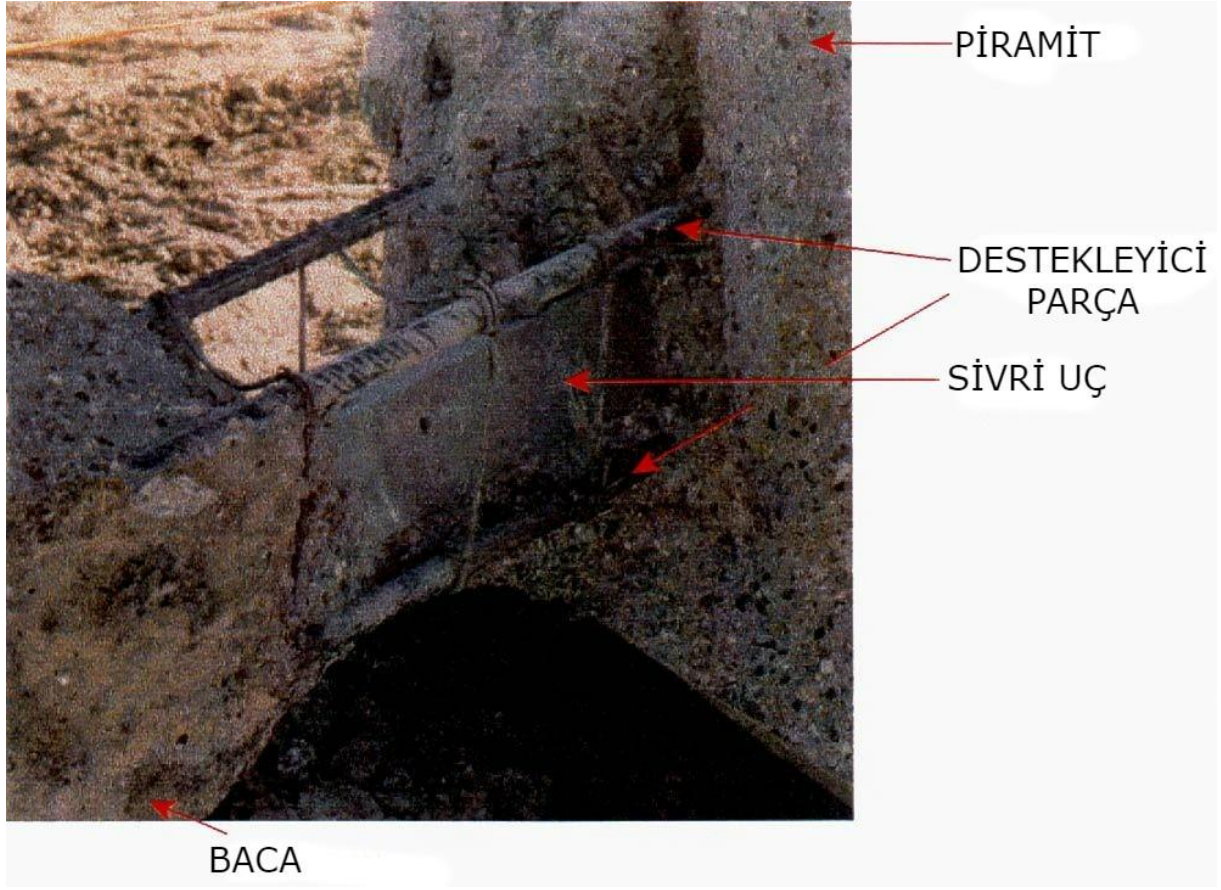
Bir beton bacadaki zayıf bir inşaat derzinin detayı
